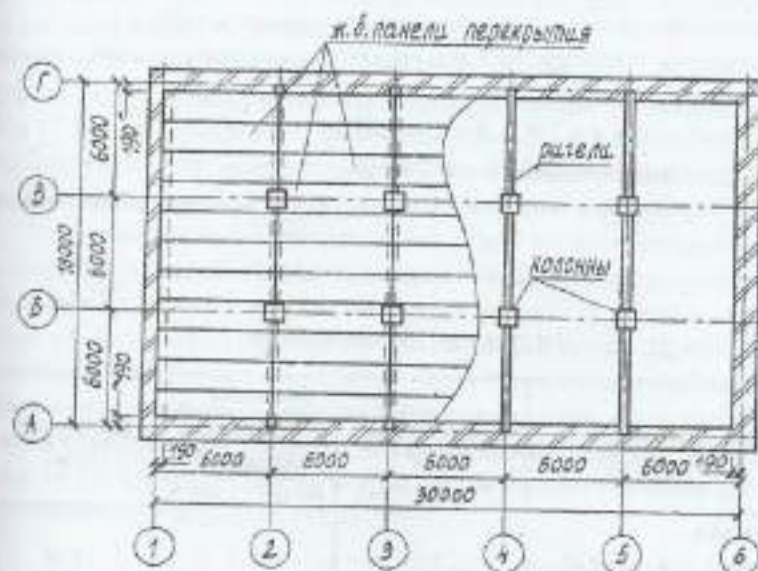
Междупэтажное перекрытие с трехпролетным ригелем
